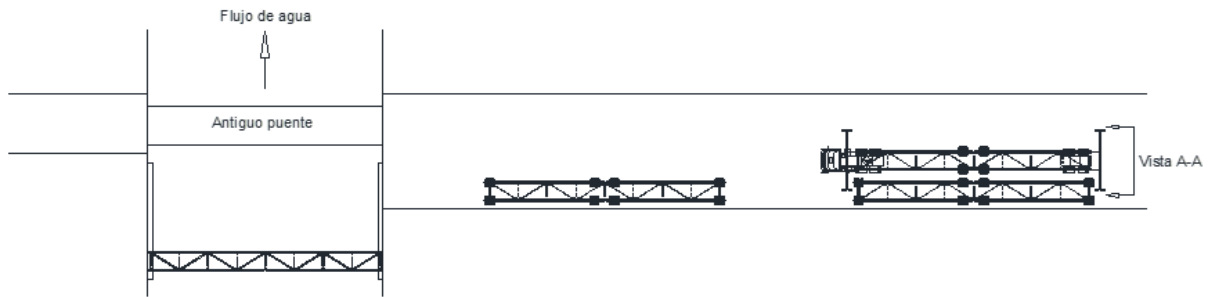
Descenso del segundo par de vigas metálicas a al dolly mediante los pórticos
